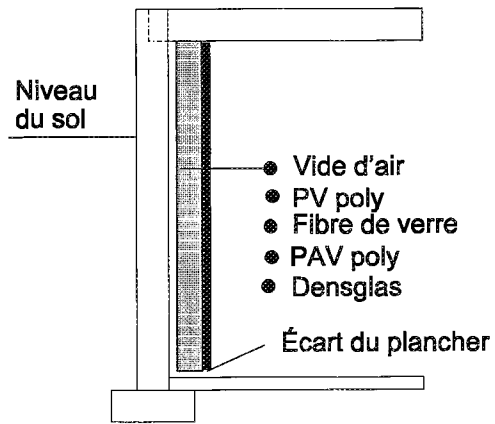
Panneau d'essai 4 – Mur à poteaux d'acier, écart entre le mur et le plancher, poly des deux côtés.
